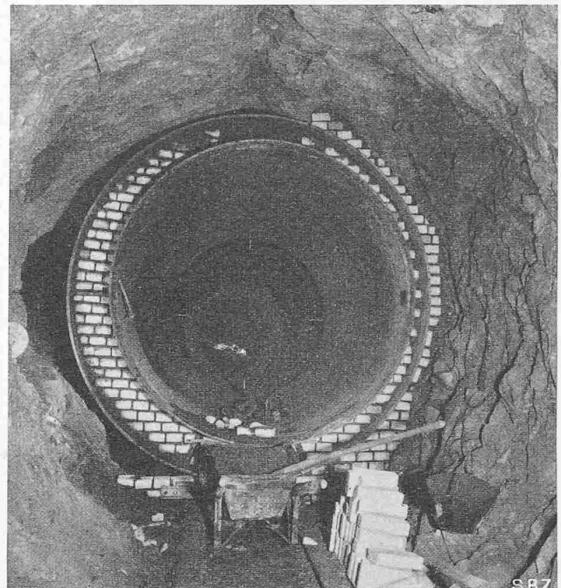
Hauptstrang der Verteilleitung. Doppelrohr, Abschalung durch Zementsteinmauerung vor dem Ausbetonieren des Zwischenraums
